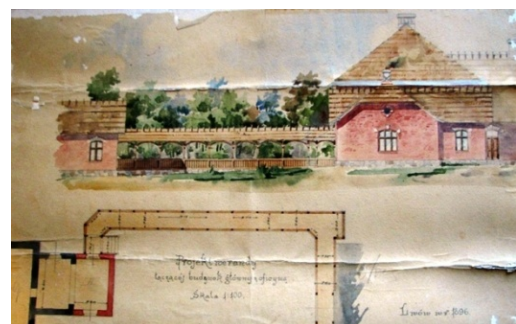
Проект веранди, що з'єднує головний будинок із флігелем у Білявині [1]
